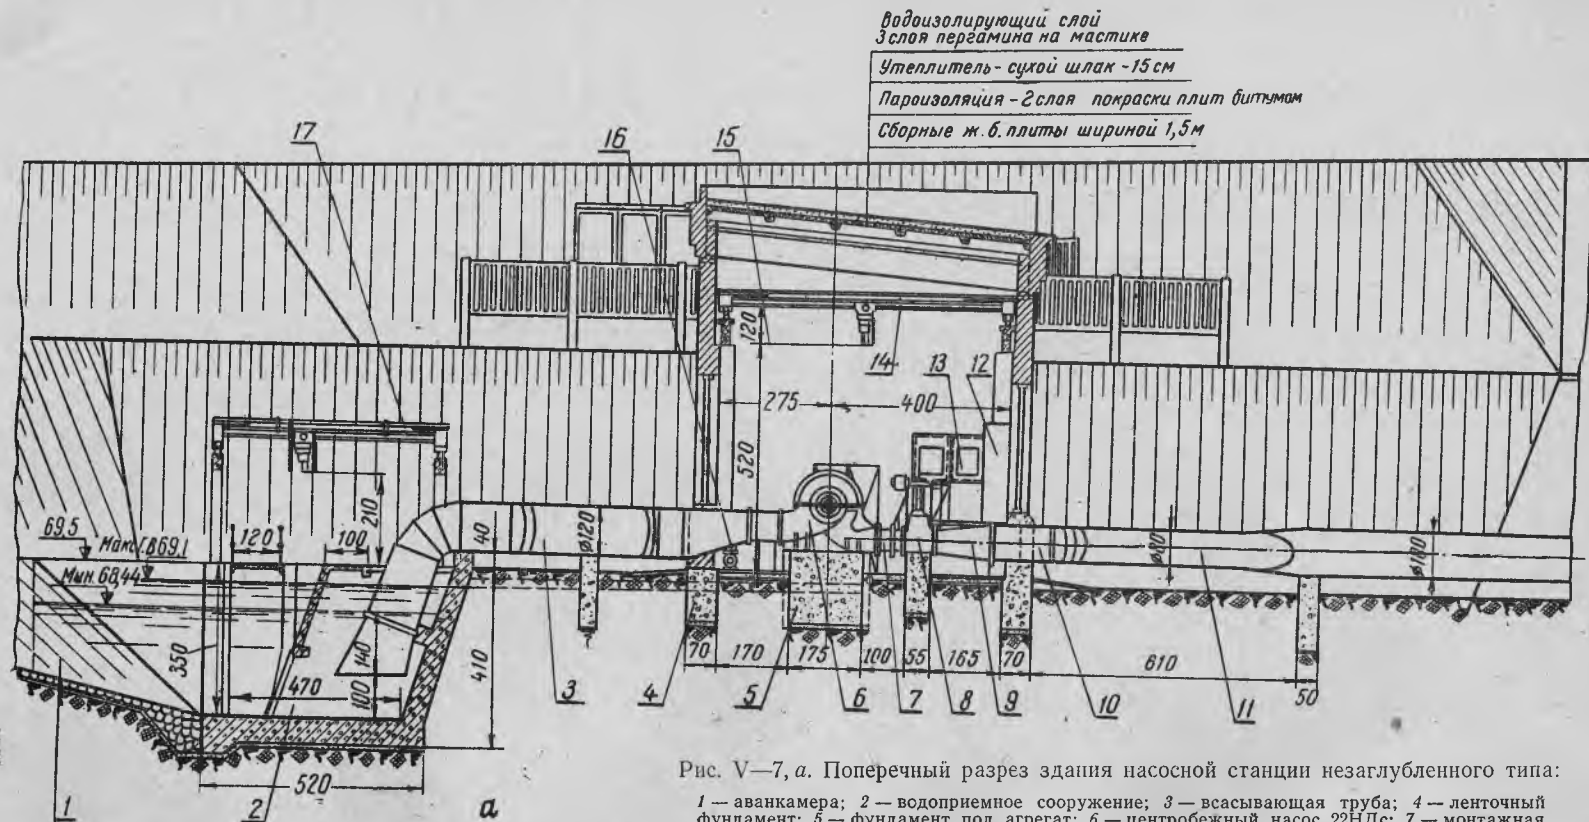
, а. Поперечный разрез здания насосной станции незаглубленного типа:
